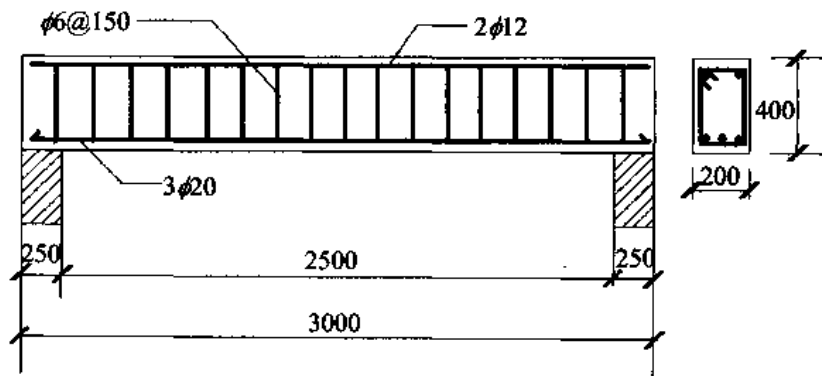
钢筋混凝土梁 (图中长度单位: mm)
